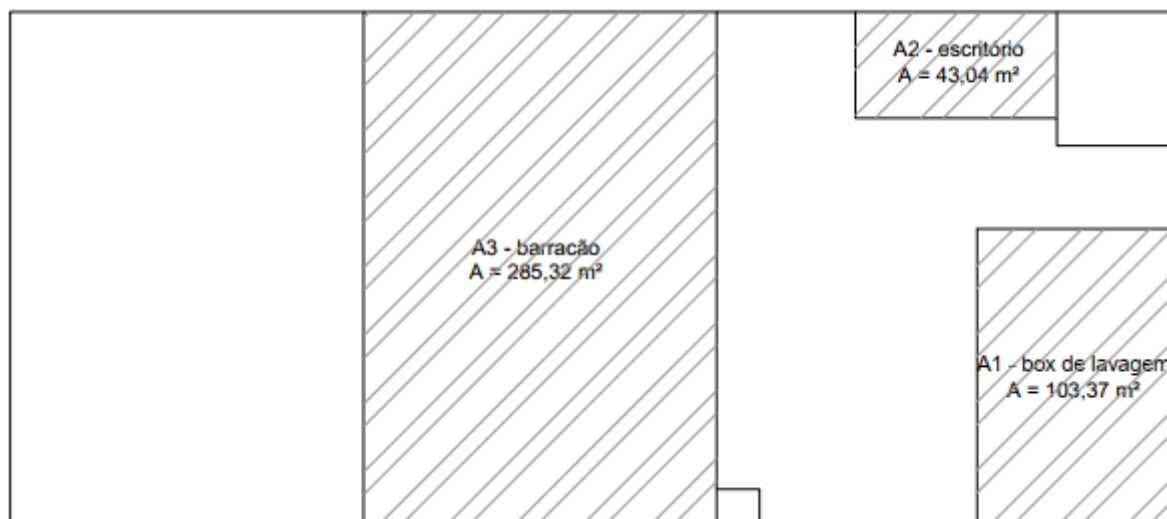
Esboço da planta do barracão e do lava car, e as possíveis áreas de captação
